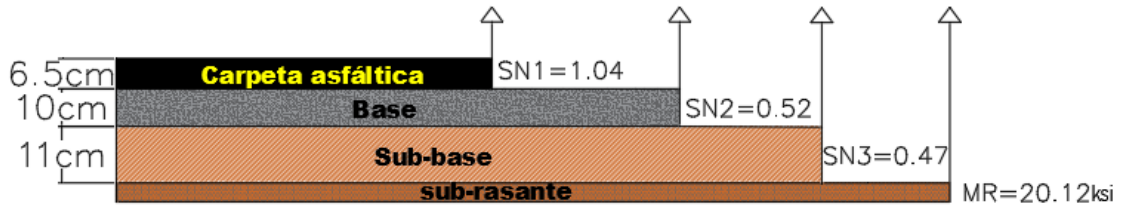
Detalle de paquete estructural de pavimento flexible diseñado
